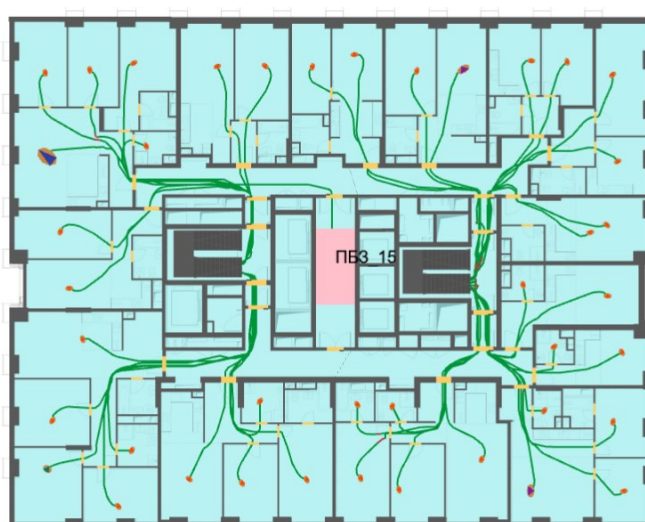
План 15-го – 31-го этажа и нанесенная на него расчетная (принципиальная) схема эвакуации
